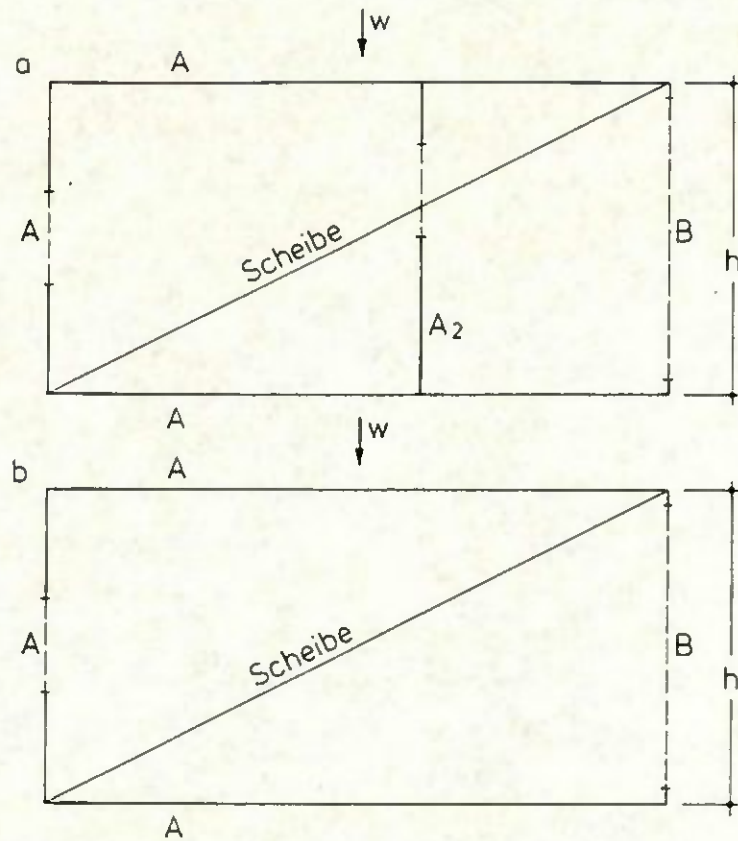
Untersuchte Deckenscheiben-Typen mit fehlendem Endauflager B (Grundriß)
